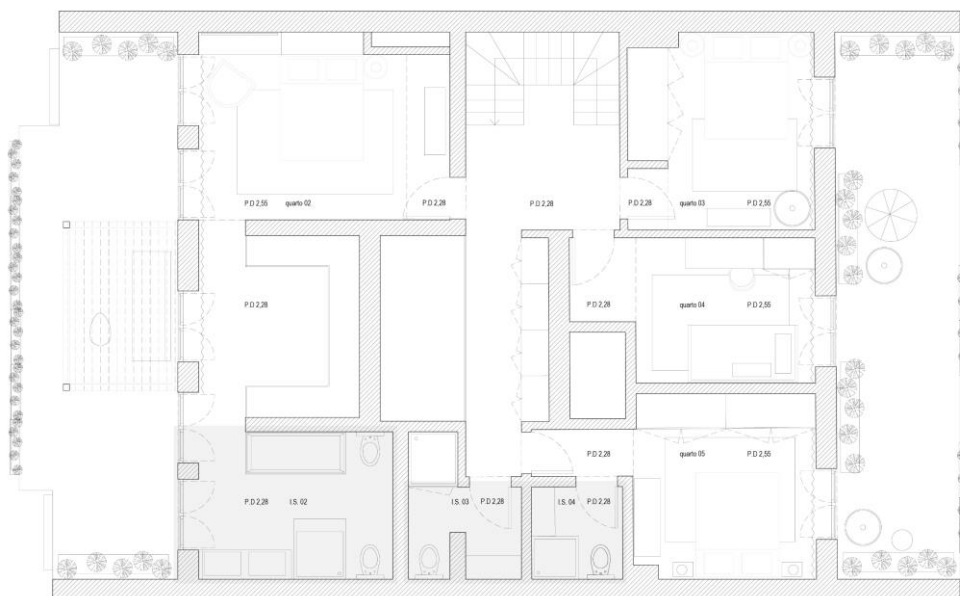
Planta do Piso 2. Projecto 5. Fonte: Arkstudio.
